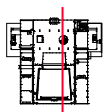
Grundriss Bestand Erdgeschoss, Maßstab 1:750
